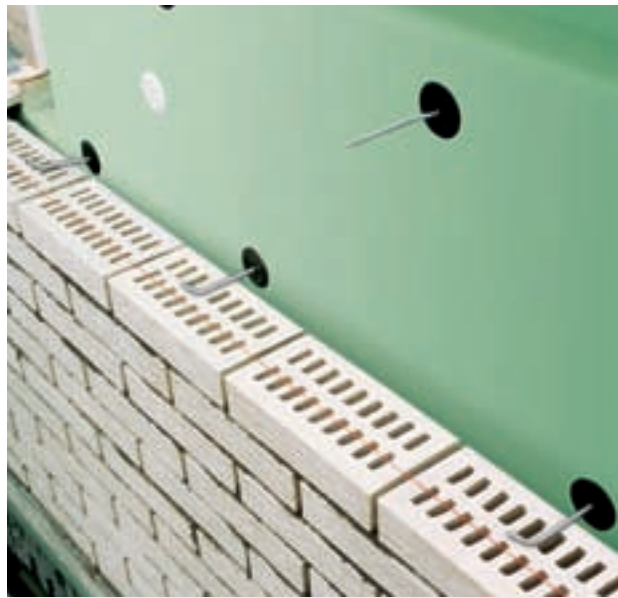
Cerramiento de la fachada de arenisca calcárea, fijación con anclajes de taladro.
